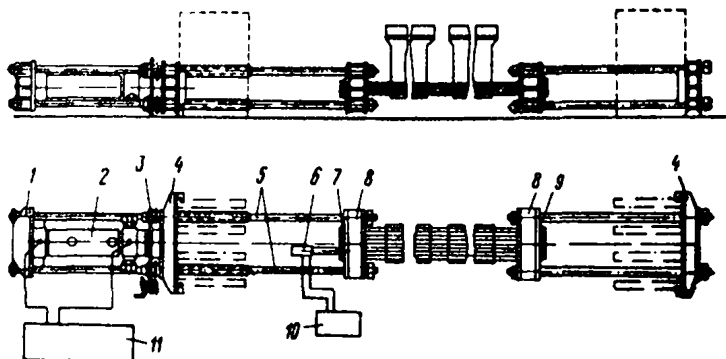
Комплект оборудования для натяжения арматуры гидродомкратом с тяговым усилием 500 т
